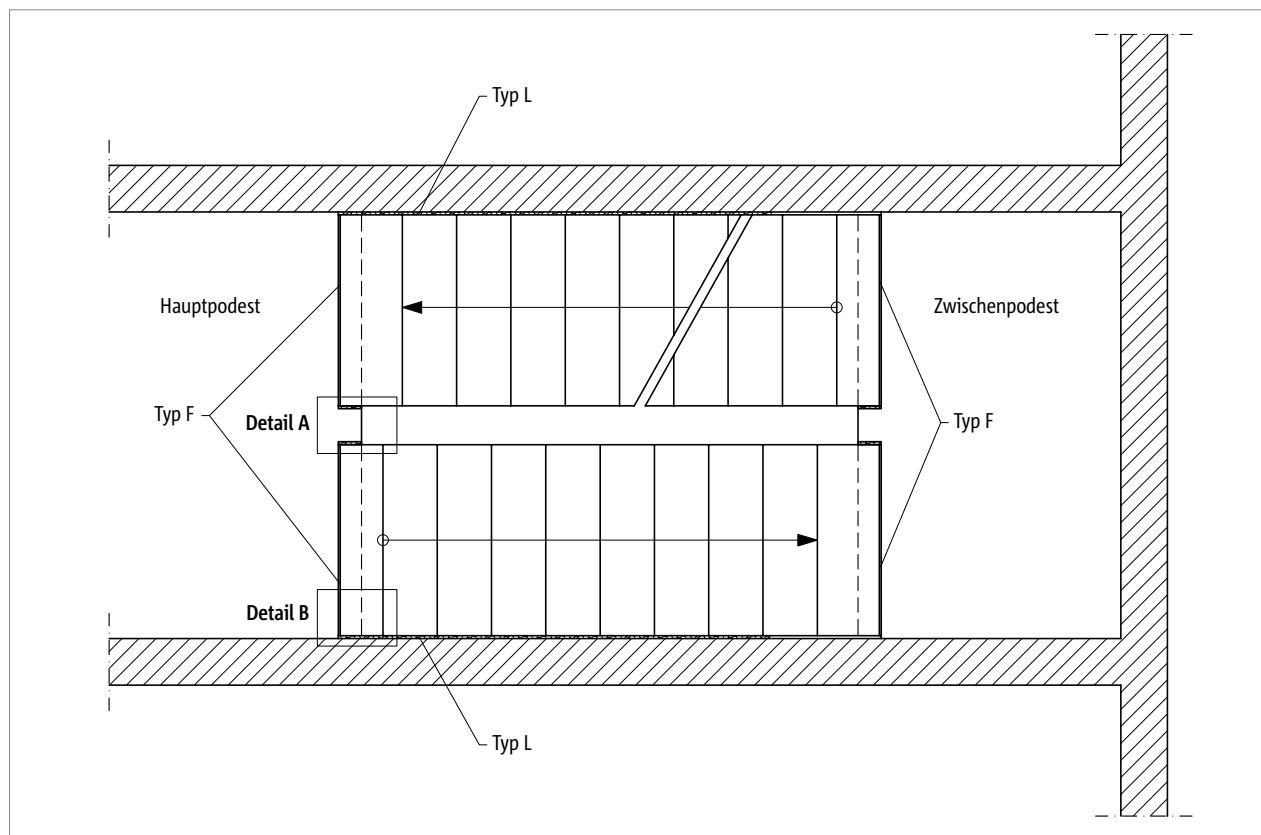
Tronsole® F: Elementanordnung im Grundriss
